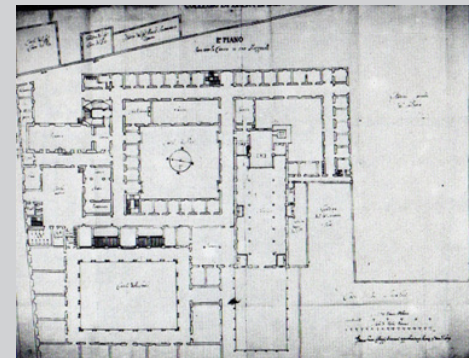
"Progetto approvato di sistemazione del pian terreno del Collegio di Brera", 1679. Roma, Archivio Gen. Gesuiti
